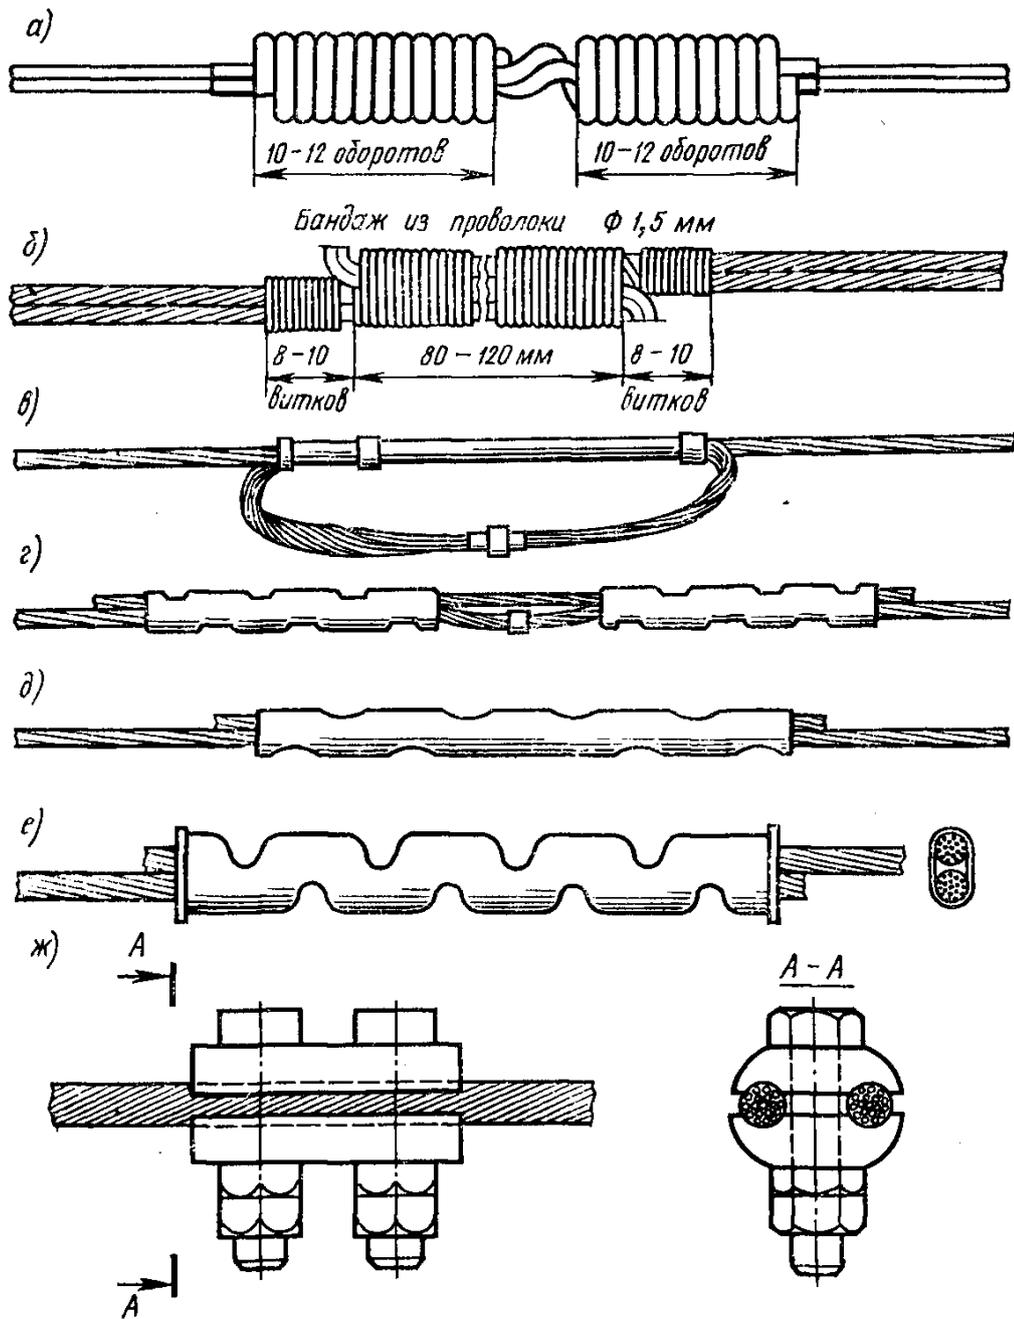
Соединение проводов ВЛ: а - скруткой; б - бандажированием внахлестку; в - опрессовкой в гильзе и сваркой в петле; г — опрессовкой провода с шунтом в овальном соединителе; д—сваркой встык и опрессовкой в гильзе; е — опрессовкой внахлестку в гильзе; ж — болтовым зажимом
